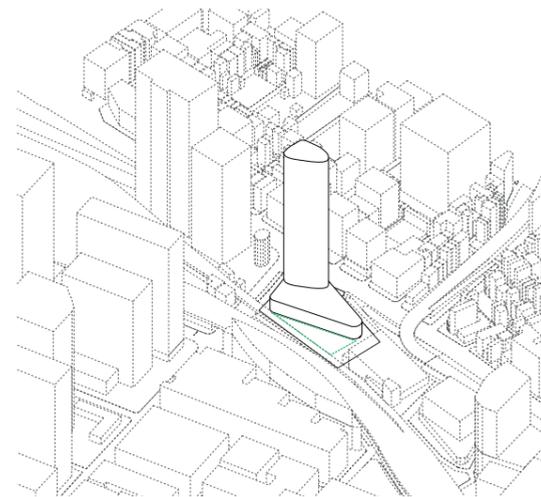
2. Städtebauliche Platzierung des Hochhauses - Dynamik der Umgebung wird im Grundriss aufgenommen - Schaffung eines Öffentlichen Platzes
